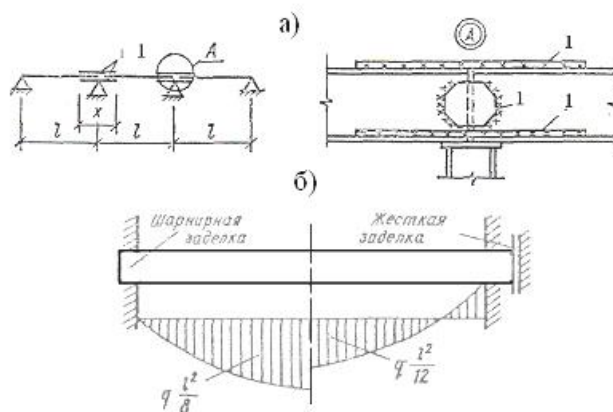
Схема усиления металлических балок путем замены шарнирной заделки на жесткую:
